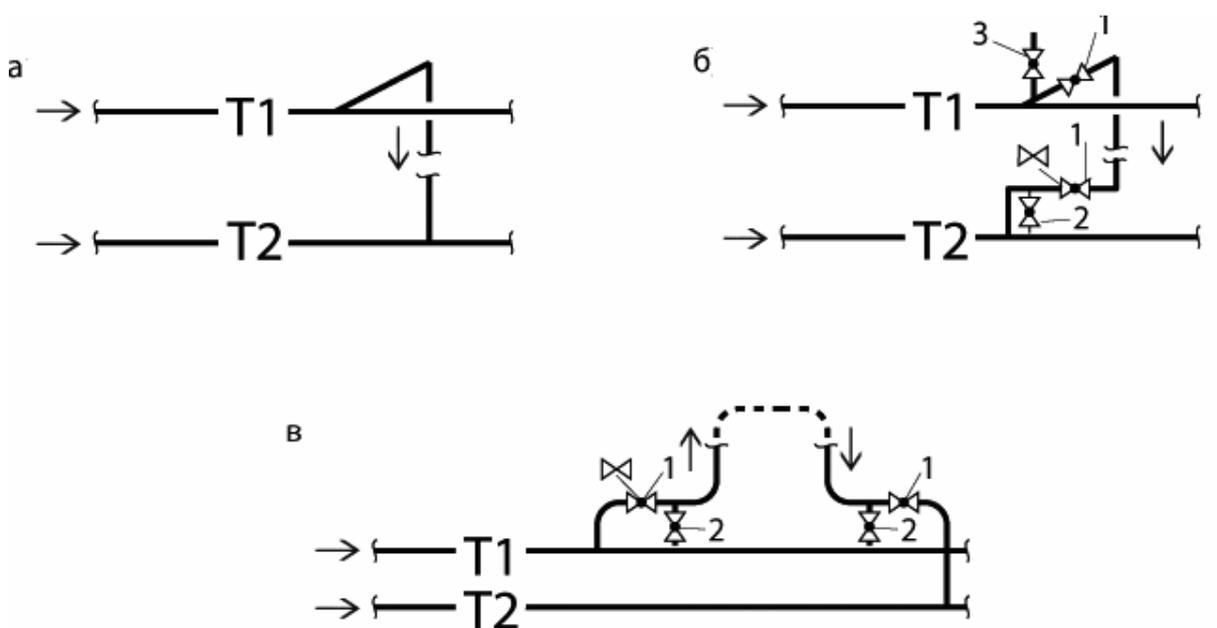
Схема установки ЗРА на стояках системы отопления разной этажности: а – двух-трехэтажных; б – четырехэтажных и более при верхней разводке; в – восьмиэтажных и более с нижней разводкой; 1 – запорный (проходной, шаровой кран или вентиль); 2 – спускной кран (проходной, шаровой кран, вентиль) со штуцером; 3 – спускной кран (проходной, шаровой, вентиль) для выпуска воздуха из стояка
